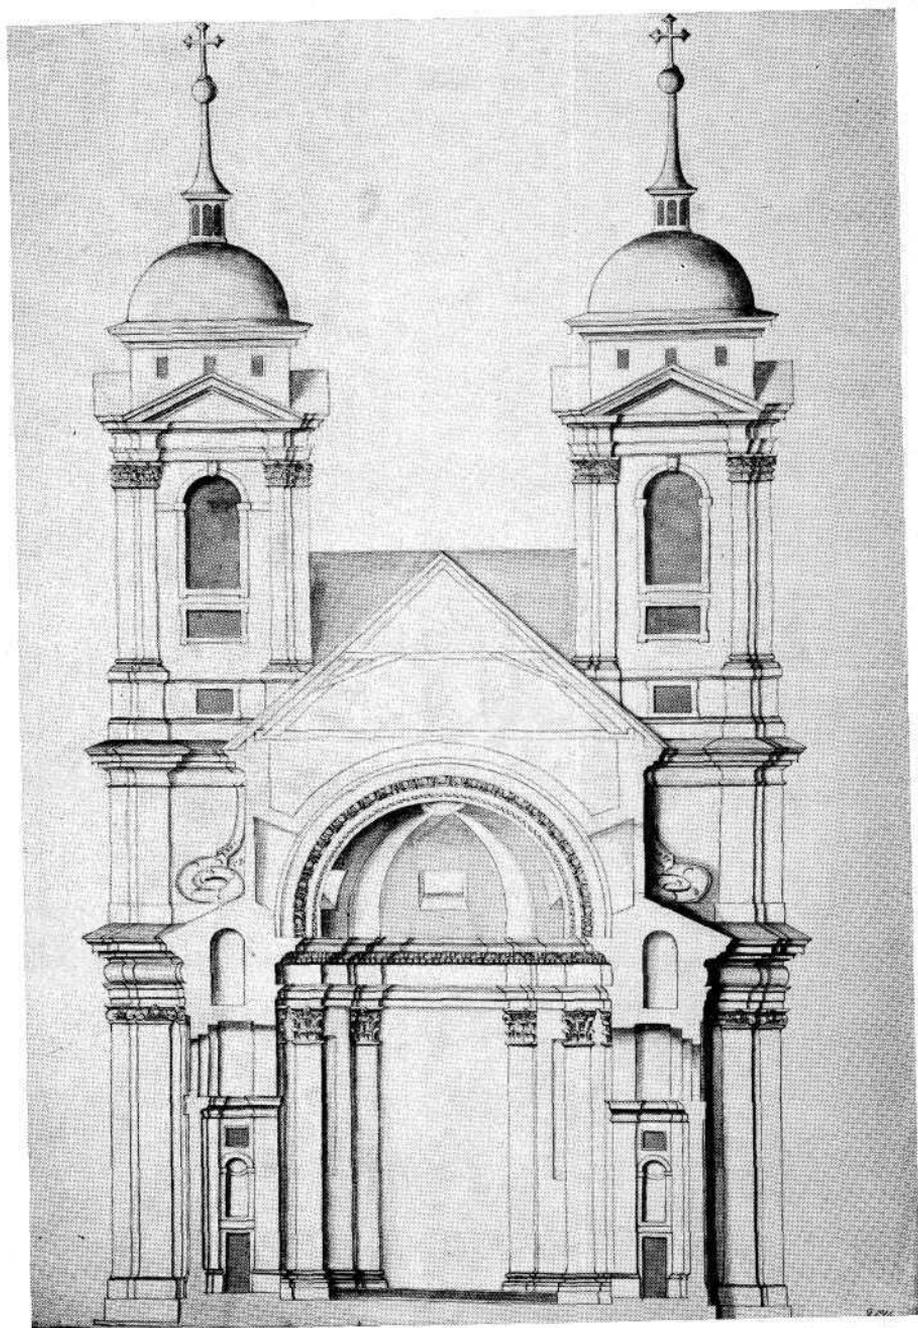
Altbunzlau, Wallfahrtskirche, Querschnitt
